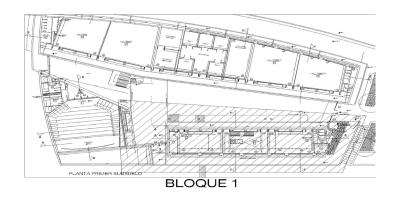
Planimetría general del proyecto. Identificación Bloque 1
